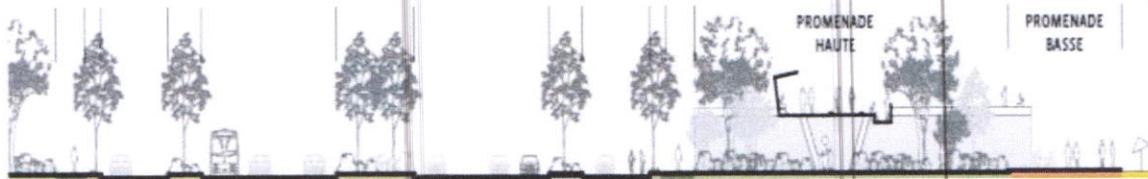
Coupe de principe sur l'aménagement de la Grande Promenade de la Baie d'Alger au droit d'une fenêtre verte
